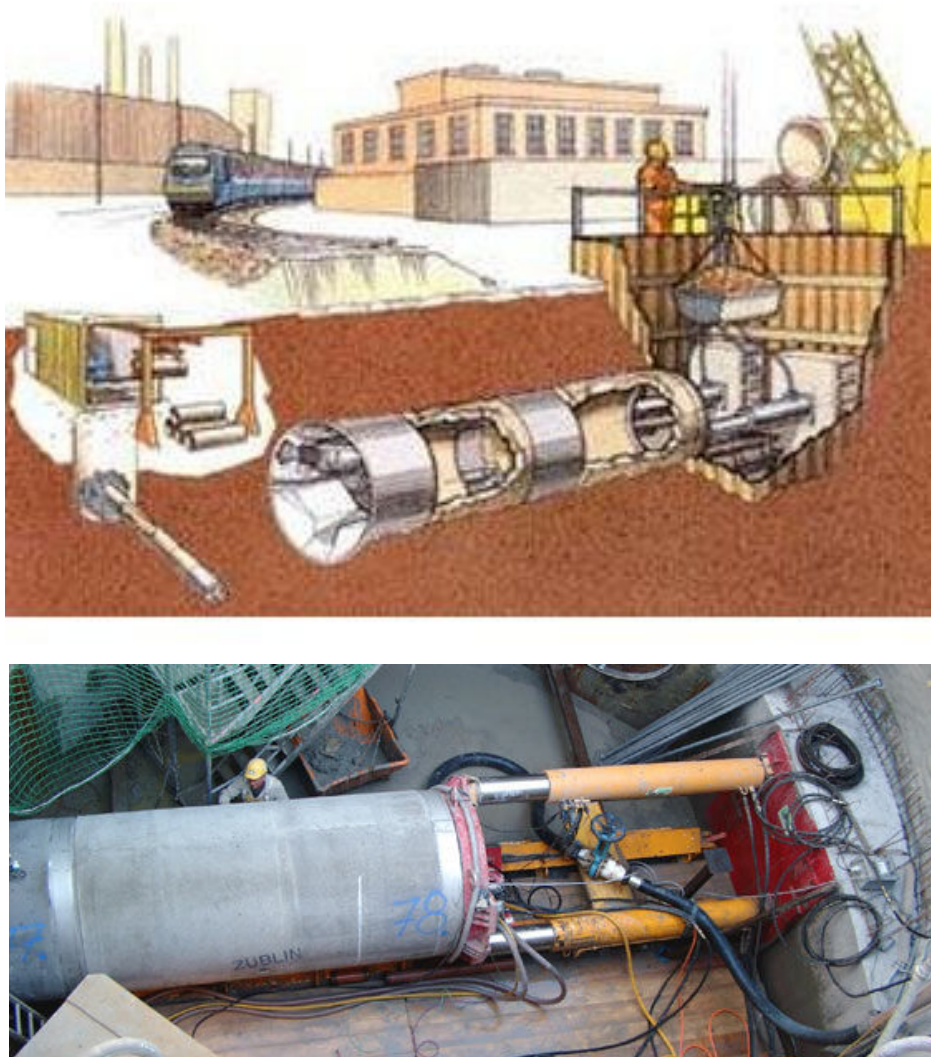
Metodología constructiva en túnel – Pipe Jacking
